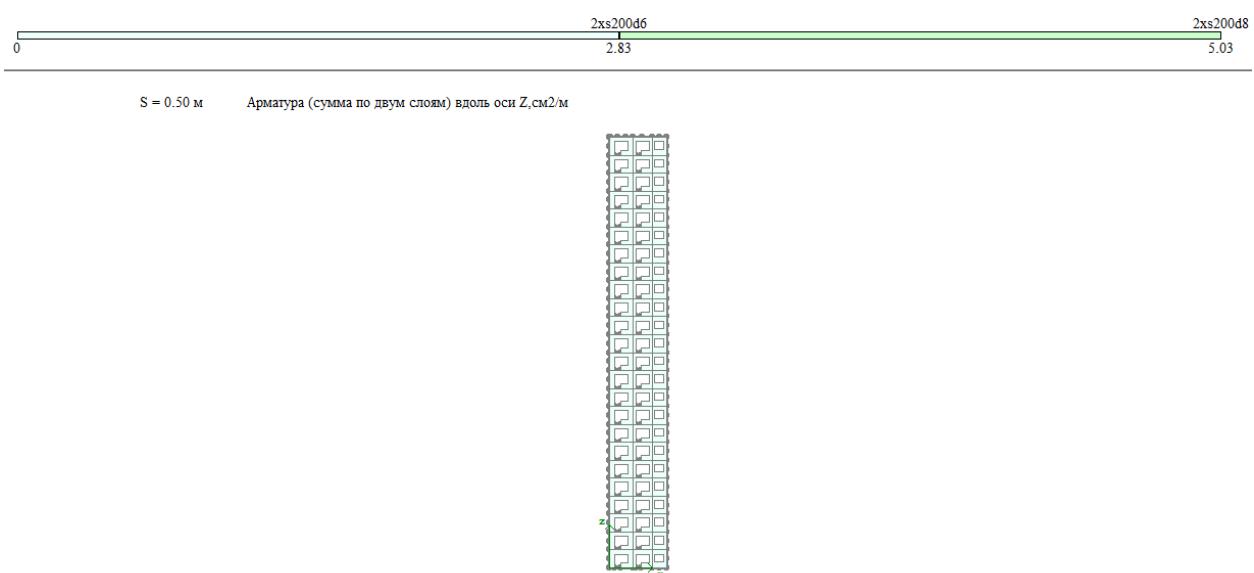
Карта необходимой площади вертикальной арматуры стены,
